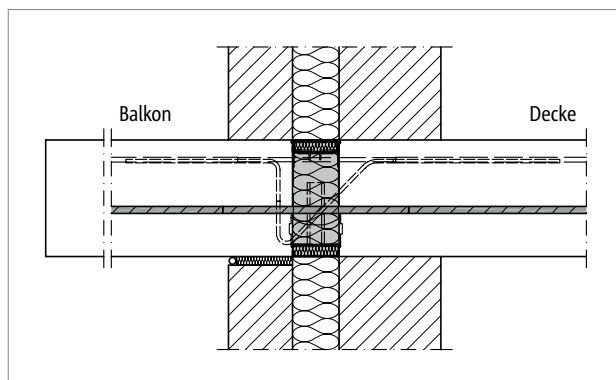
Schöck Isokorb® T Typ K, H-NN: Mauerwerk mit Kerndämmung
